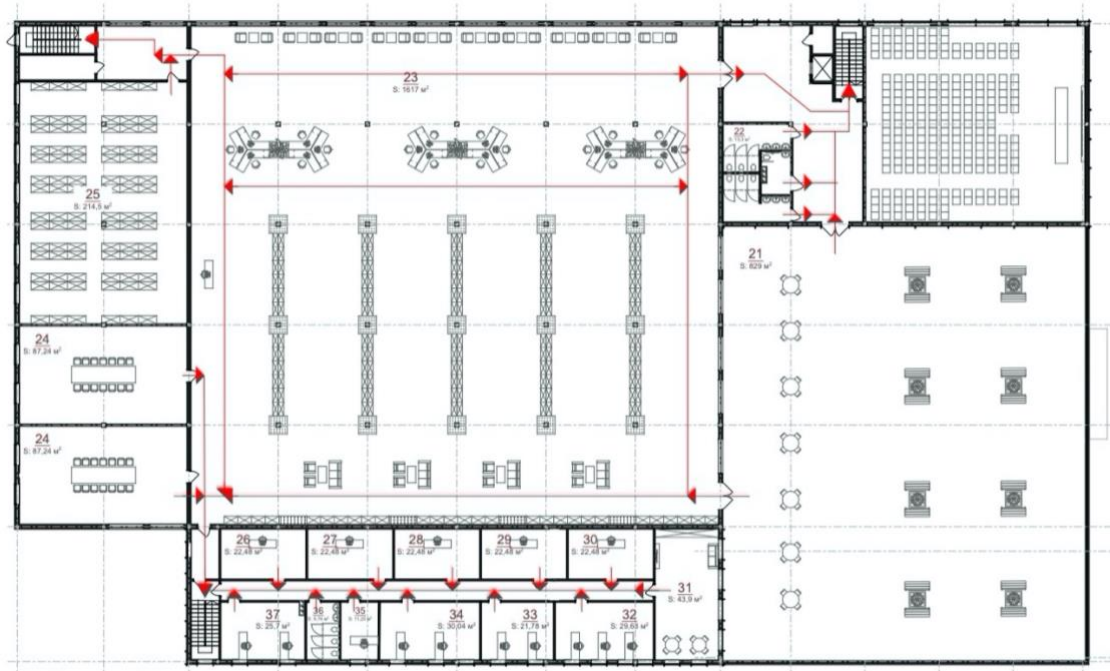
План евакуації з приміщень бібліотеки 2-го поверху.
